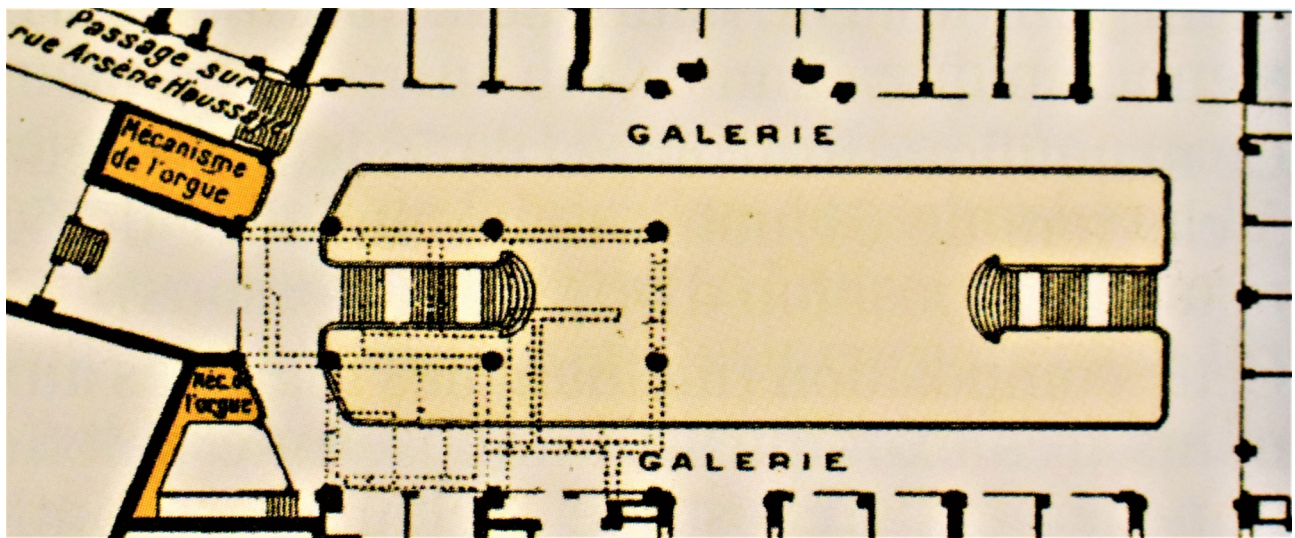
Plan du hall principal des Portiques des Champs-Élysées
